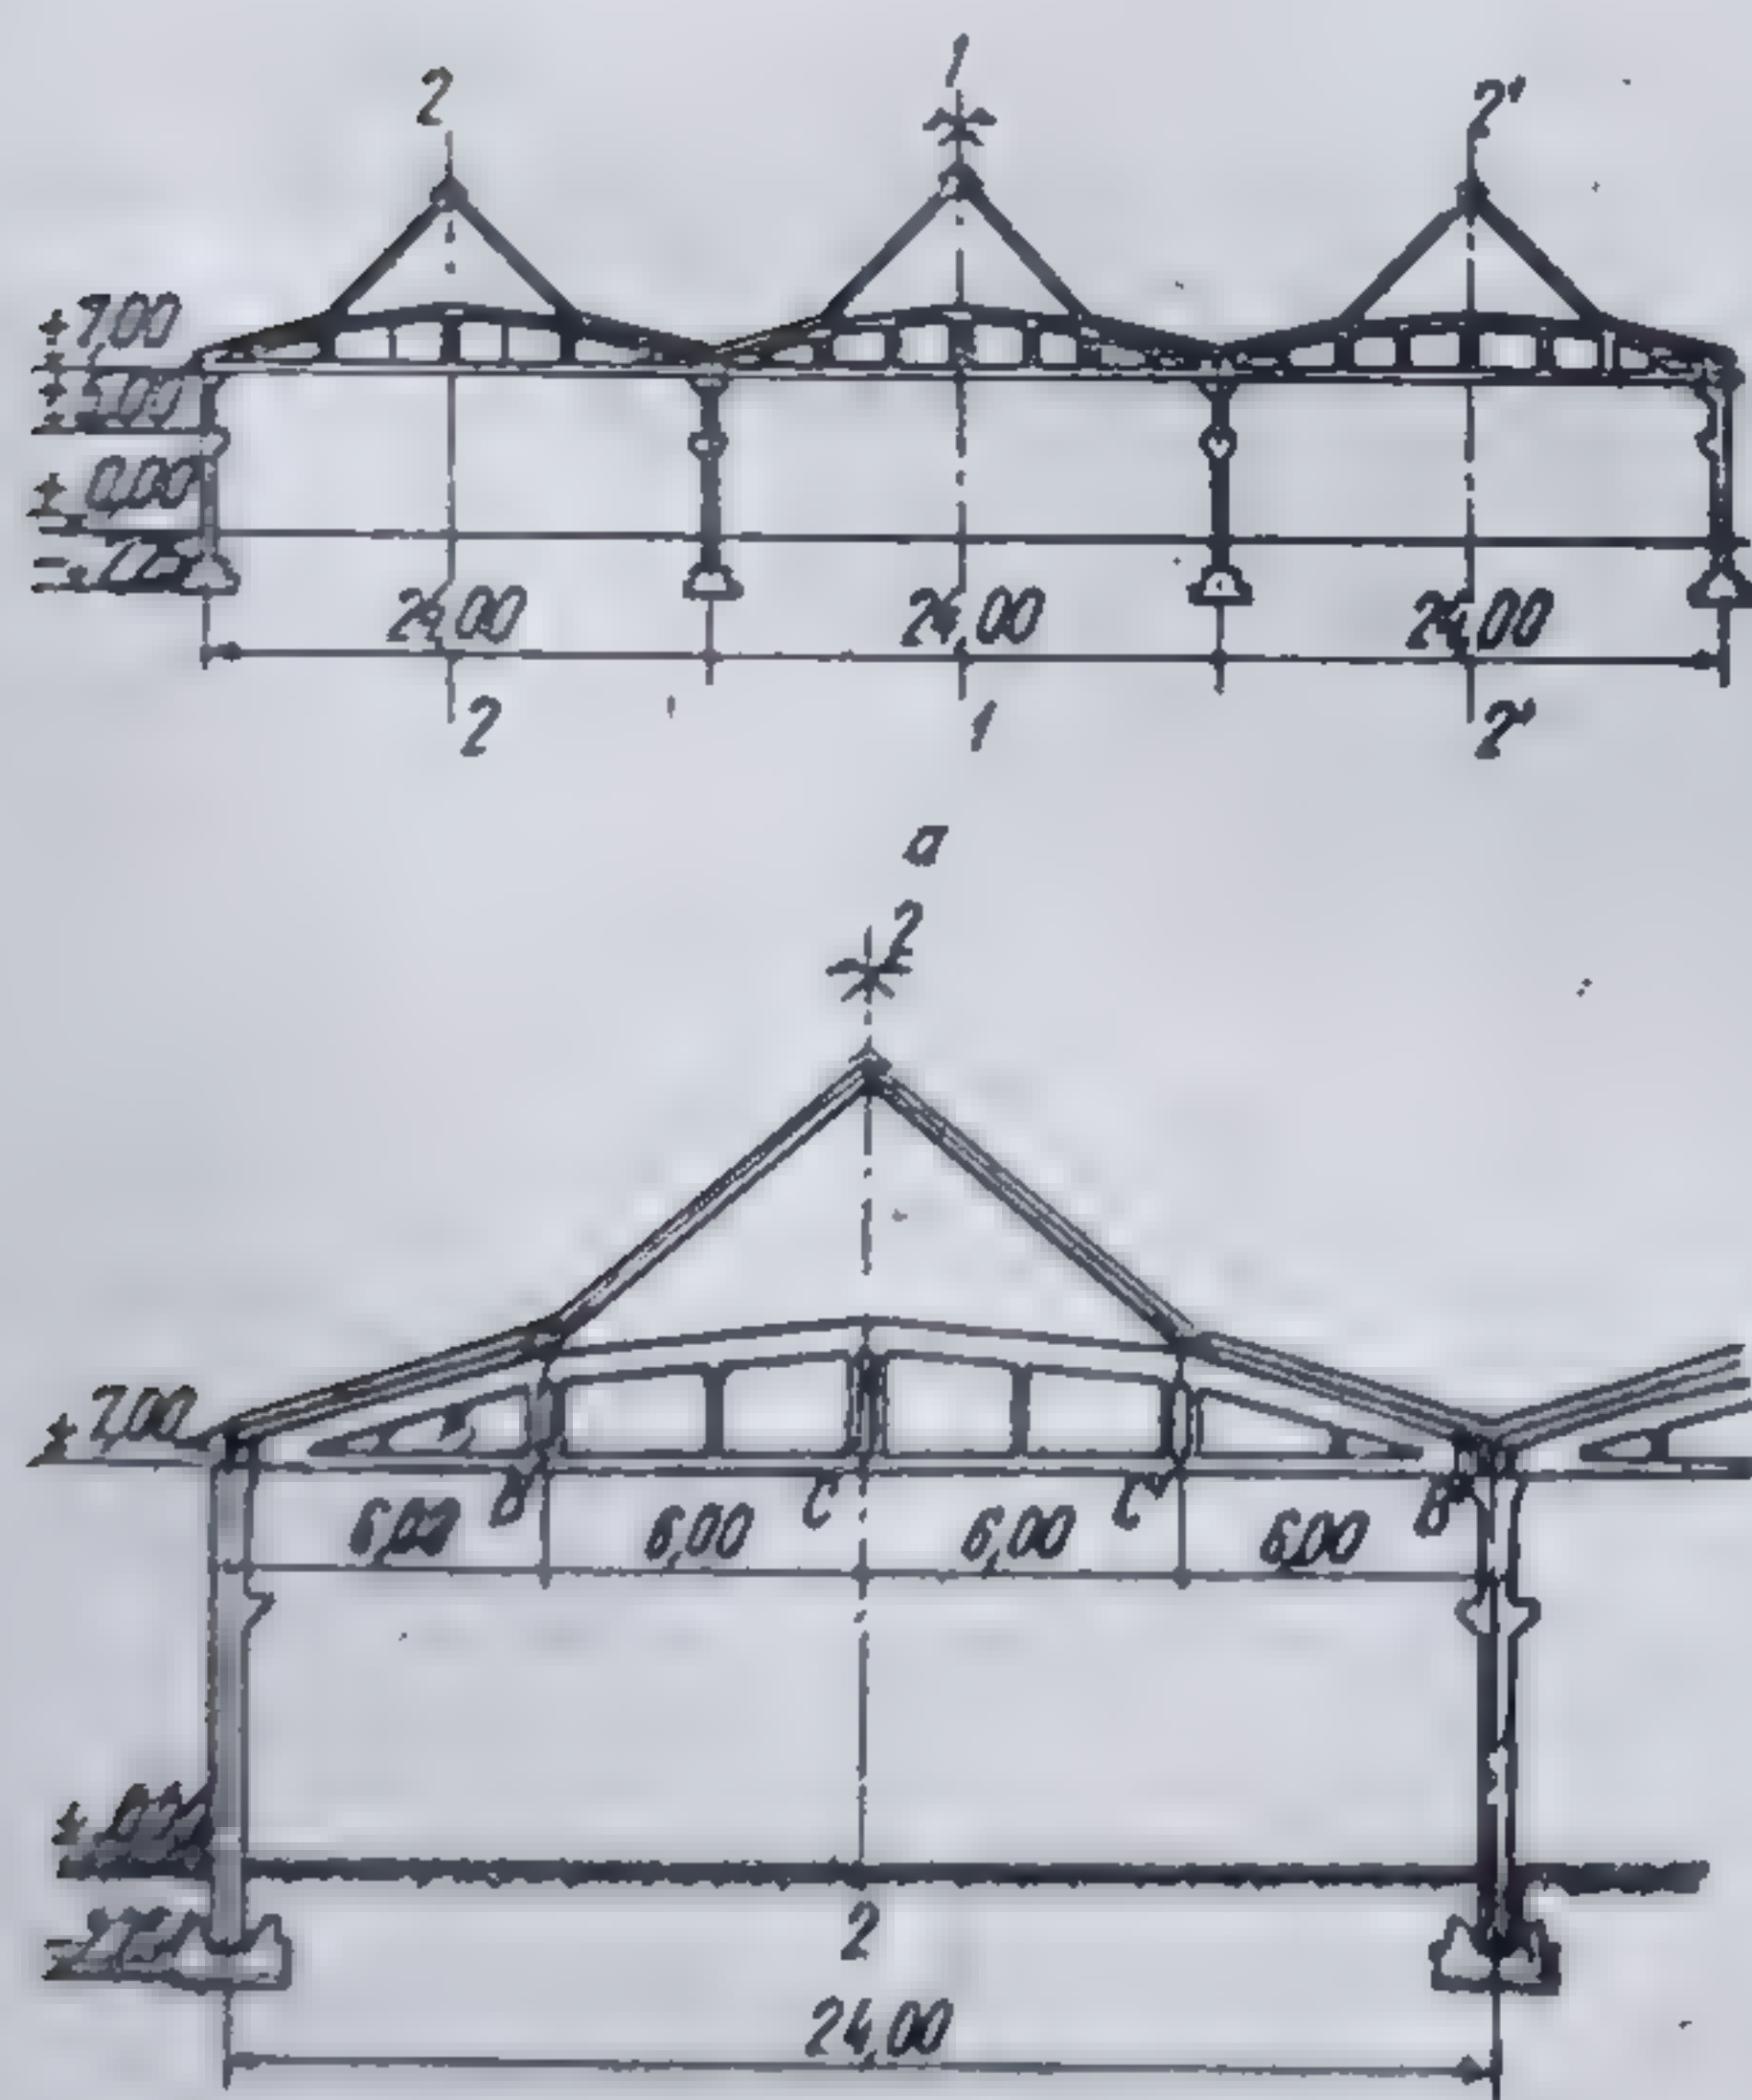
Folosirea elementelor de simetrie la desenarea unui ansamblu simetric (hală cadre cu elemente prefabricate):
